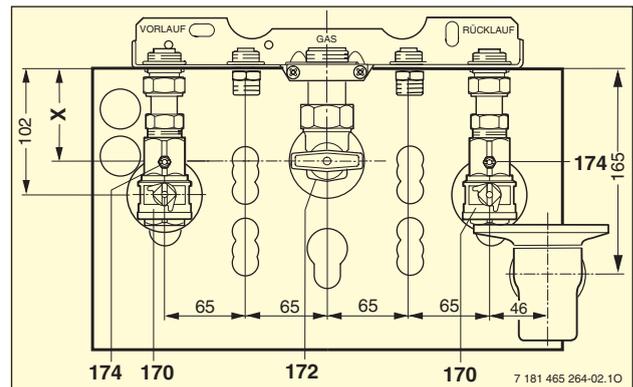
Montageanschlussplatte mit Unterputz-Installation (fertig montiert)
